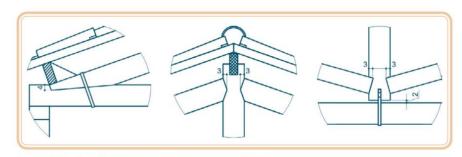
Detalhes dos encaixes ou ensambladuras
